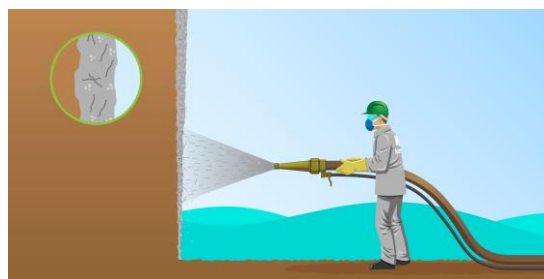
Aplicação do concreto projetado com fibras adaptando as irregularidades do corte
